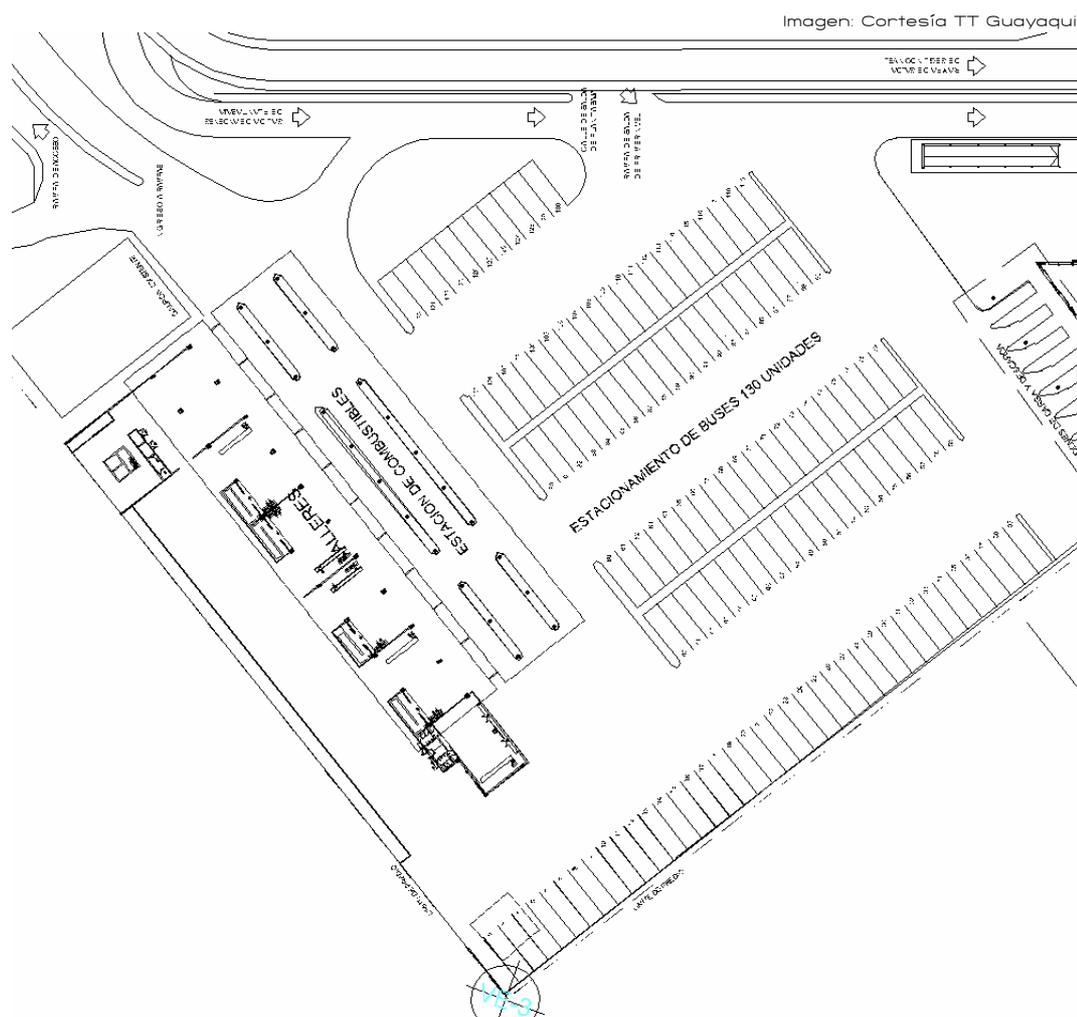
Planta arquitectónica del área de talleres y andenes de espera
